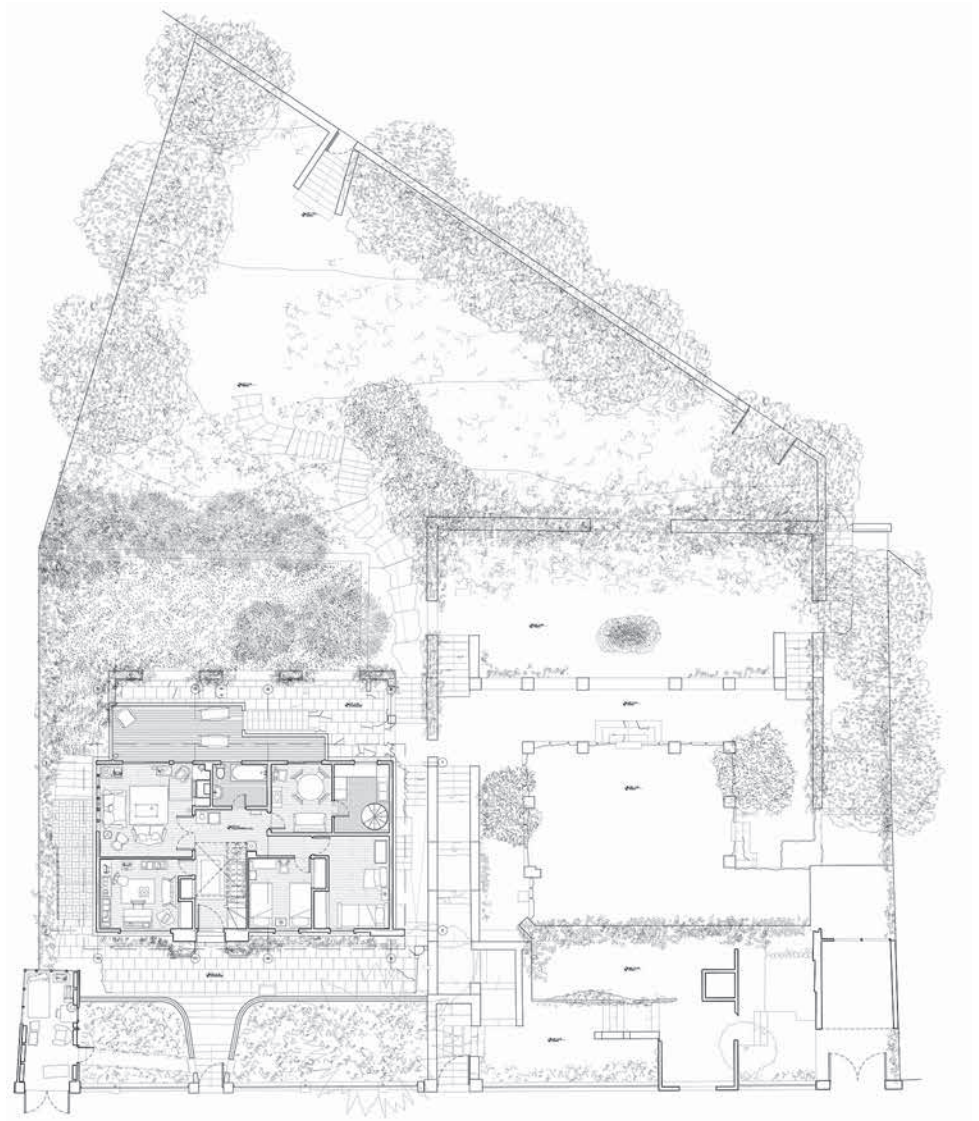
Taller Quite the Opposite. Planimetría Casa Nicanor Parra en Las Cruces, Chile, 2018. © Bárbara Salazar.
